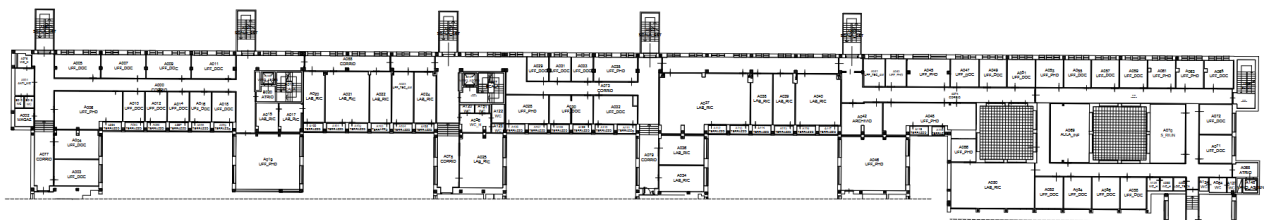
Pianta del secondo piano post-ampliamento con distribuzione degli spazi [5]
